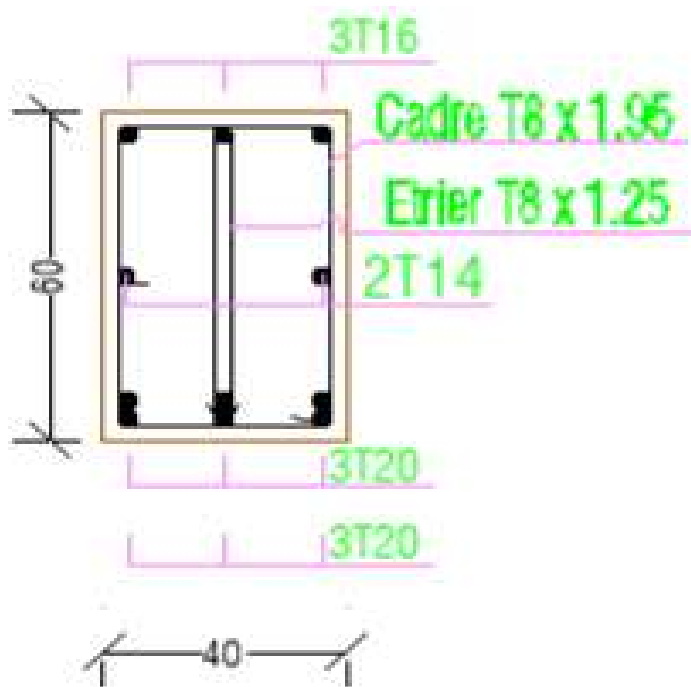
Disposition constructive des armatures des poutres en travée
